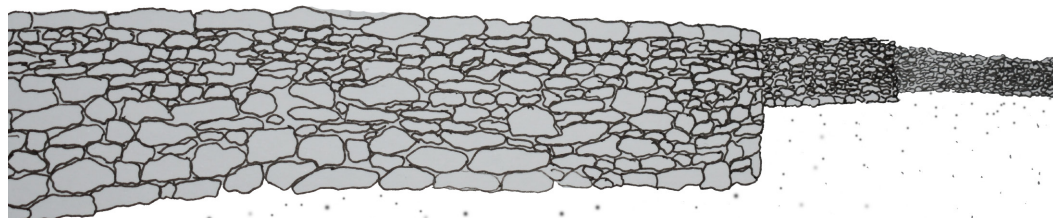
Dibujo de un muro de piedra seca. Fuente: Imagen propia.
